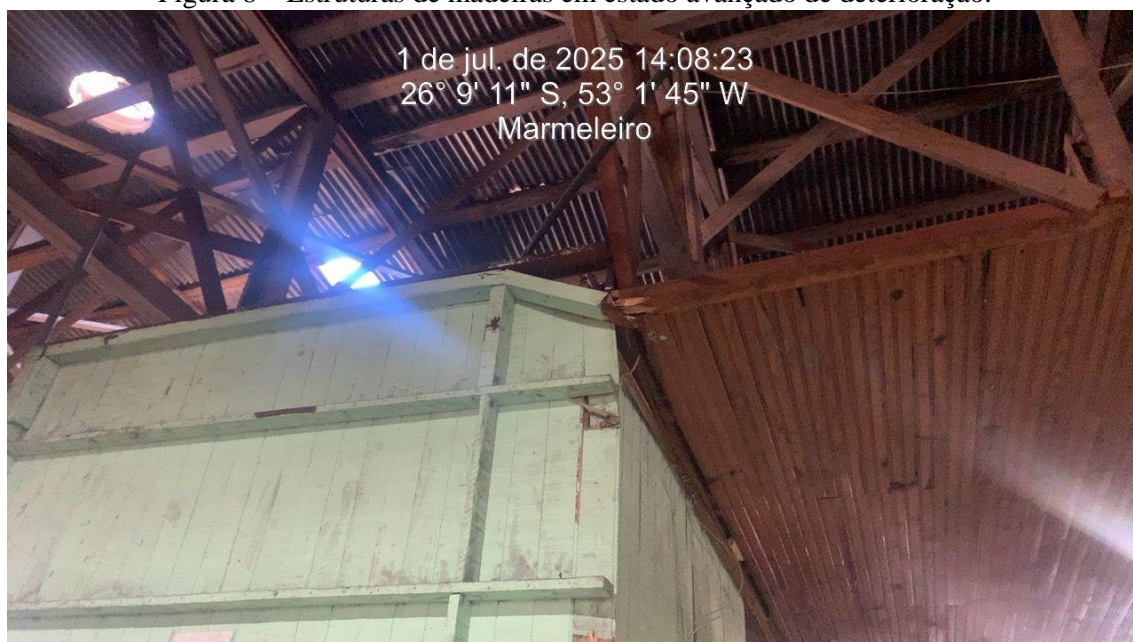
Estruturas de madeiras em estado avançado de deterioração.
